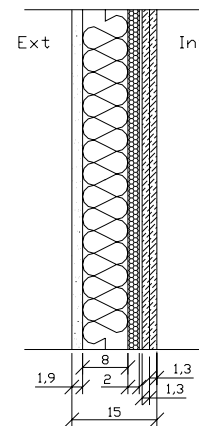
Parede dupla leve tipo painel sandwich
